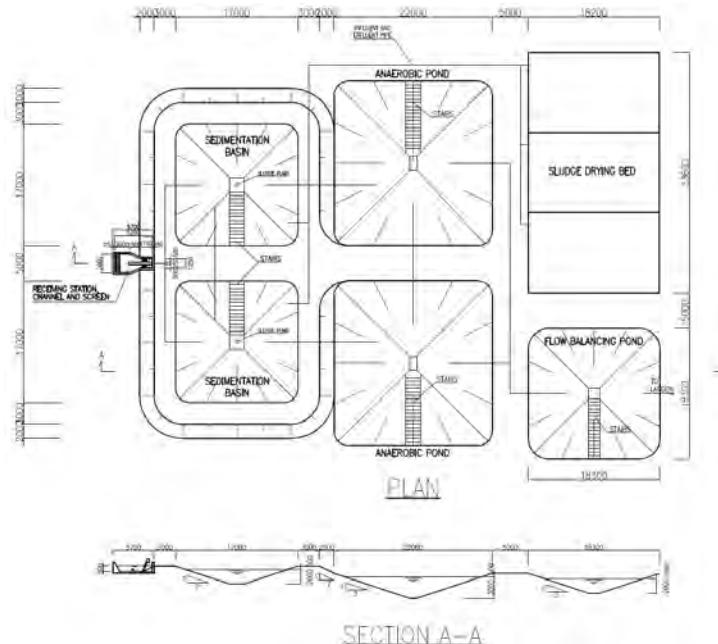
廃敗槽汚泥処理施設の平面および断面図
